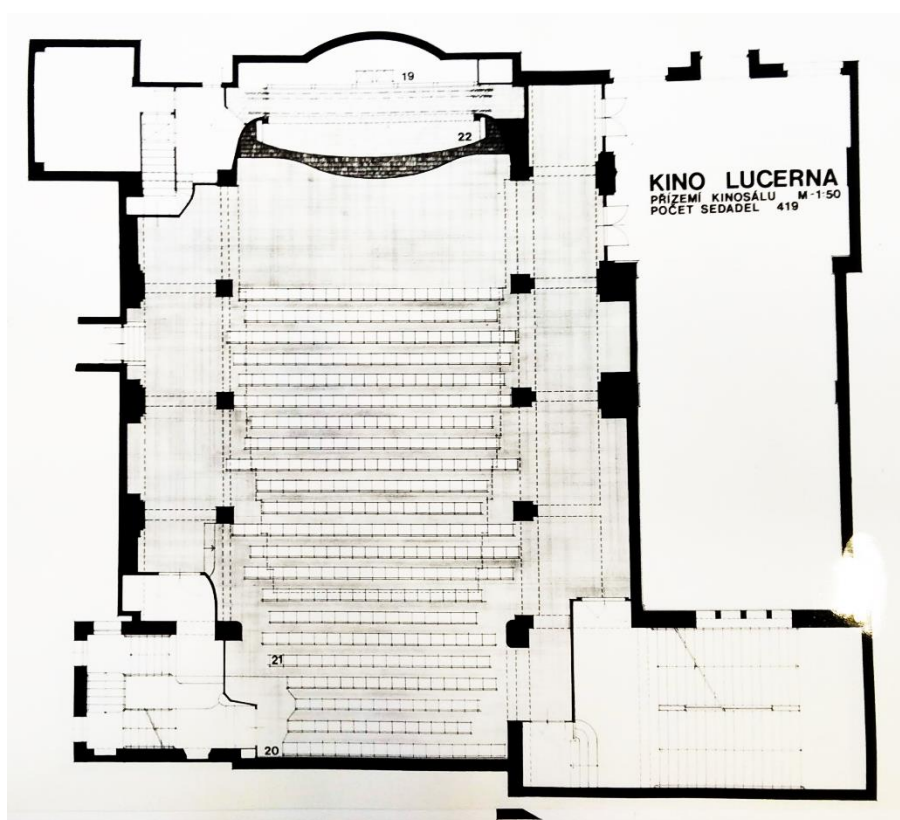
Lucerna – půdorys kinosálu, 90. léta, zdroj: Archiv hlavního města Prahy
